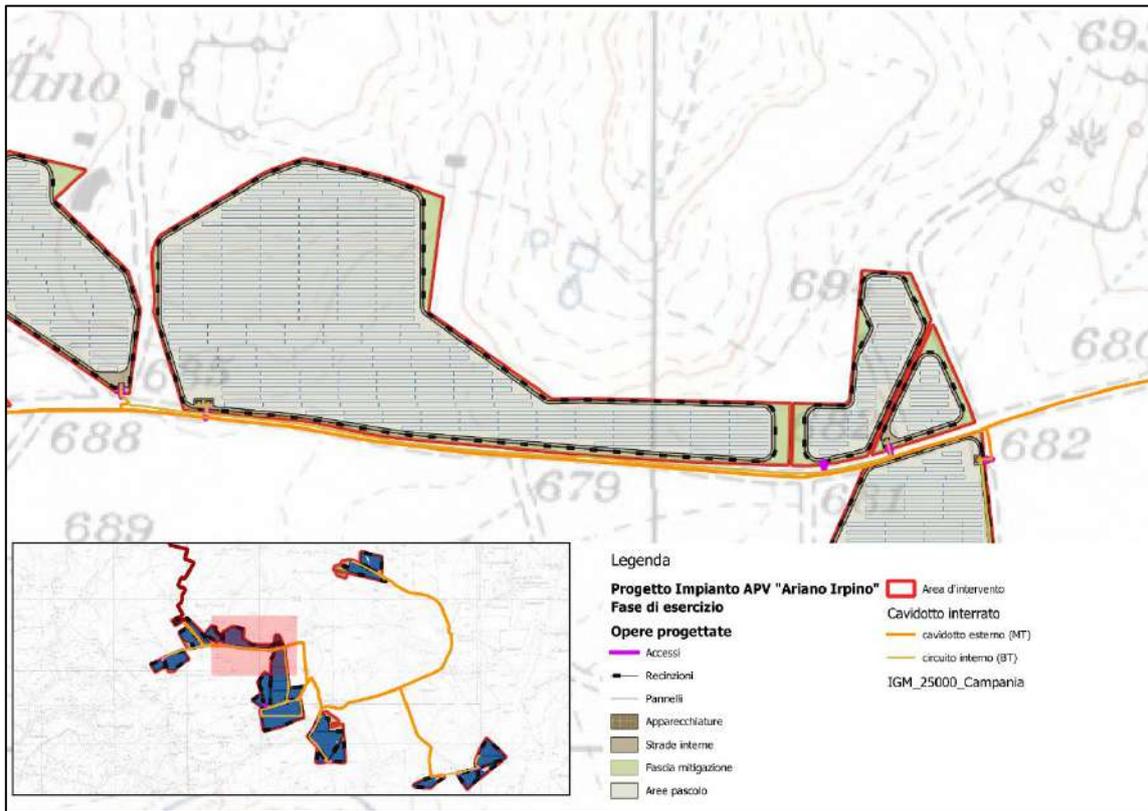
planimetria riportante i campi fotovoltaici in fase di esercizio
